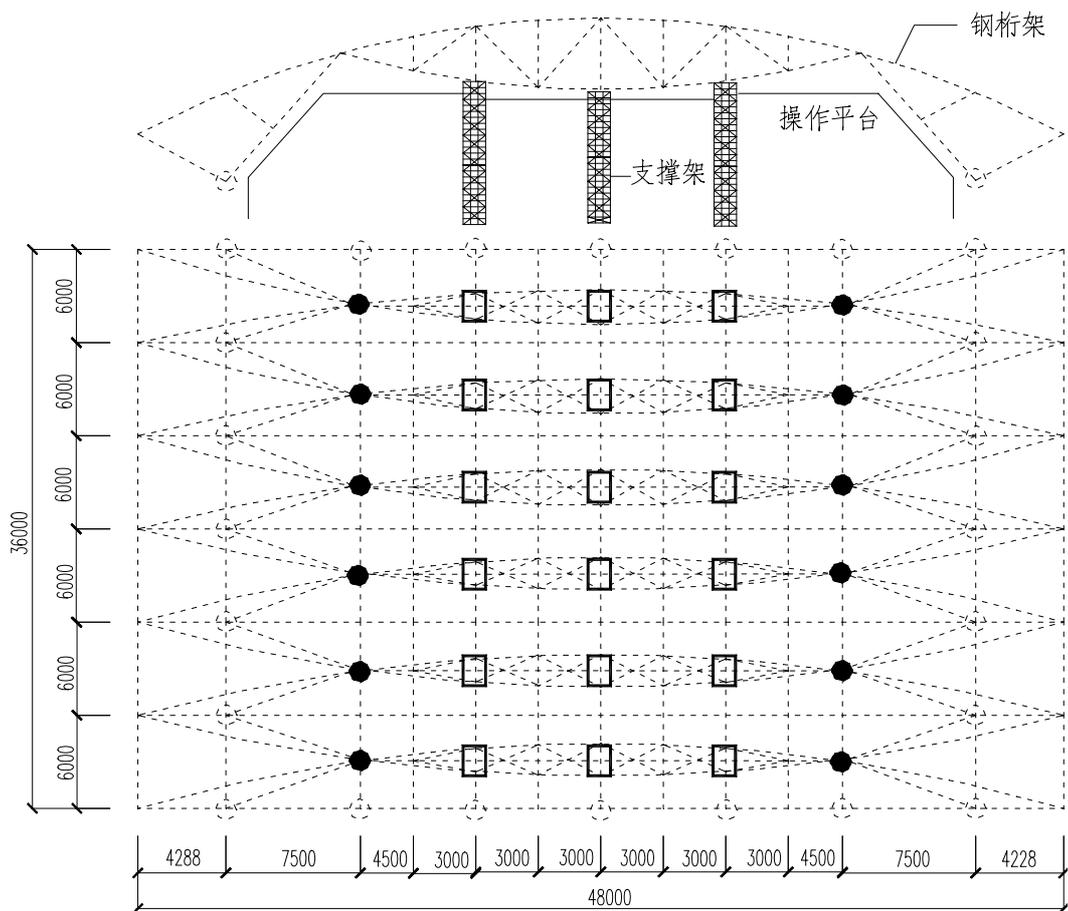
篮球馆内钢桁架支撑格构平面布置图
